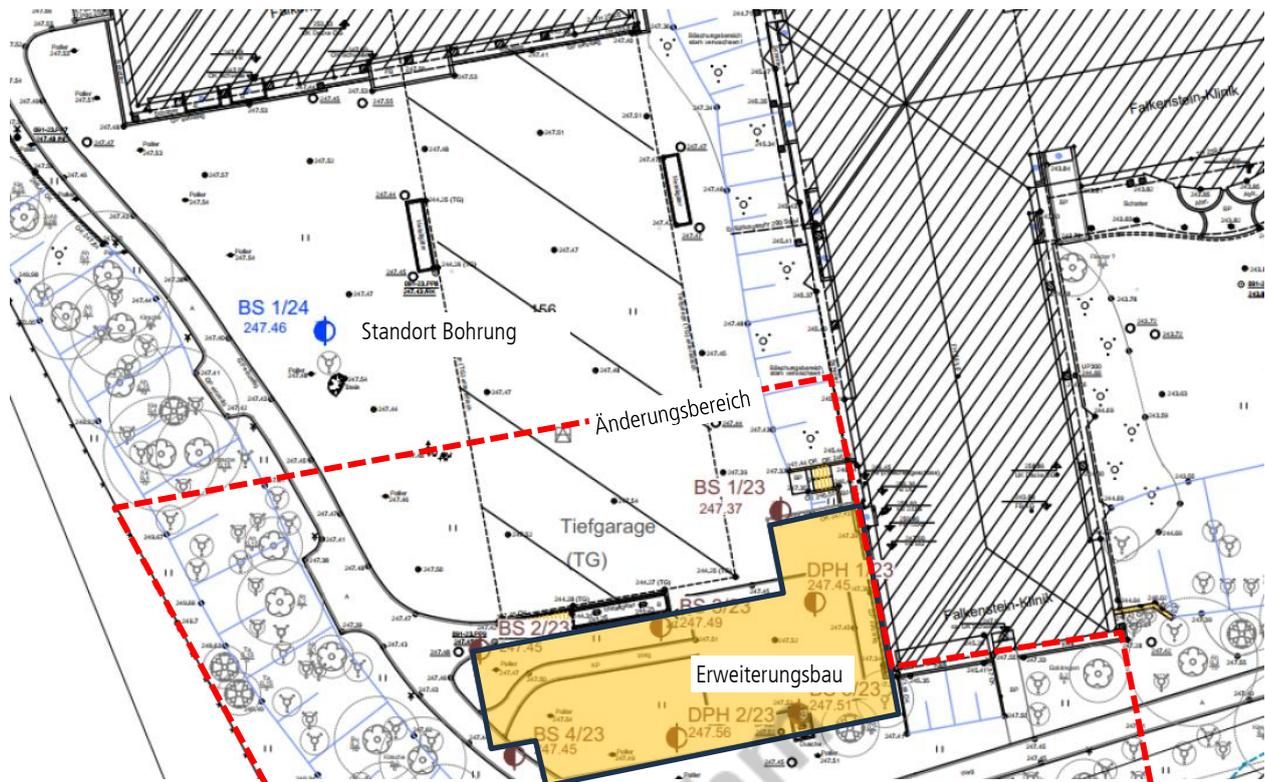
Übersicht Lage Versickerungsstandort (Quelle: Baugrund Dresden 2025)
